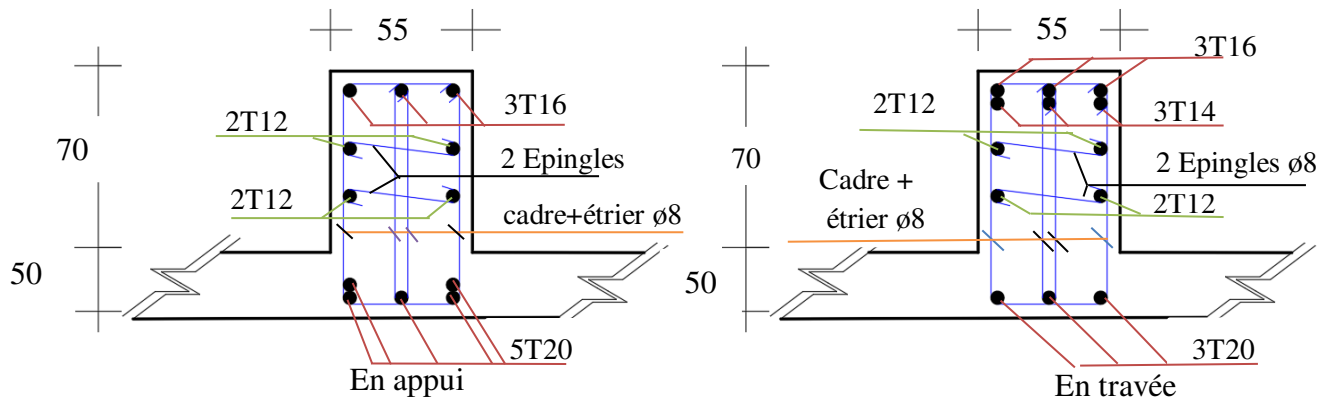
Ferrailage de la poutre principale en travée et en appui.
